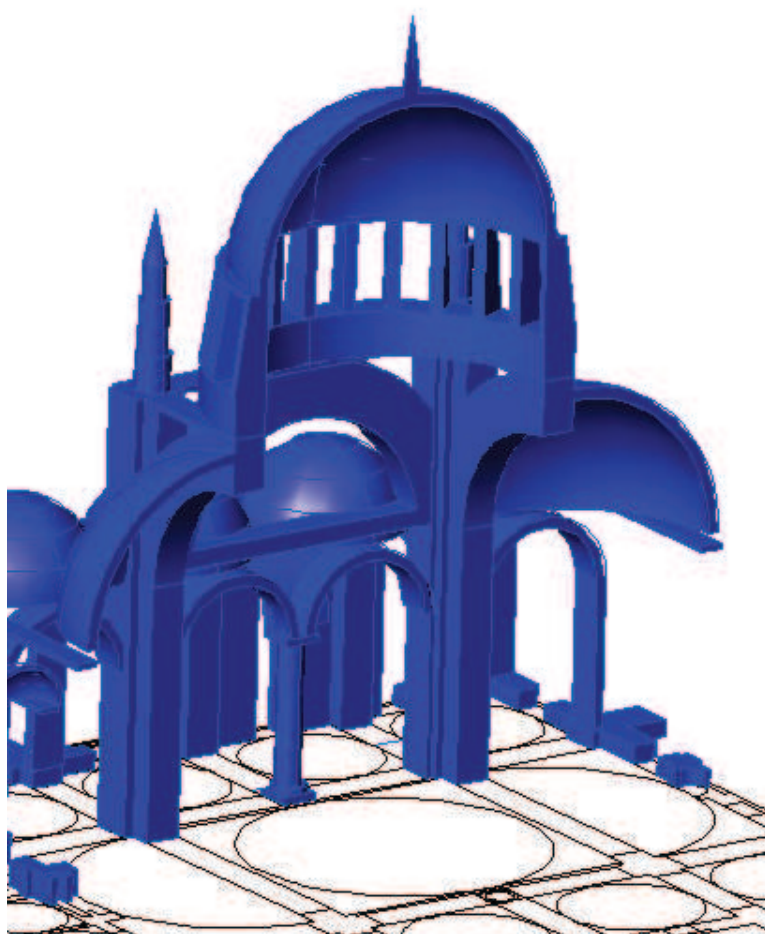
Mezquita de Bayaceto II, sección longitudinal. (Construcción 3D del autor)
